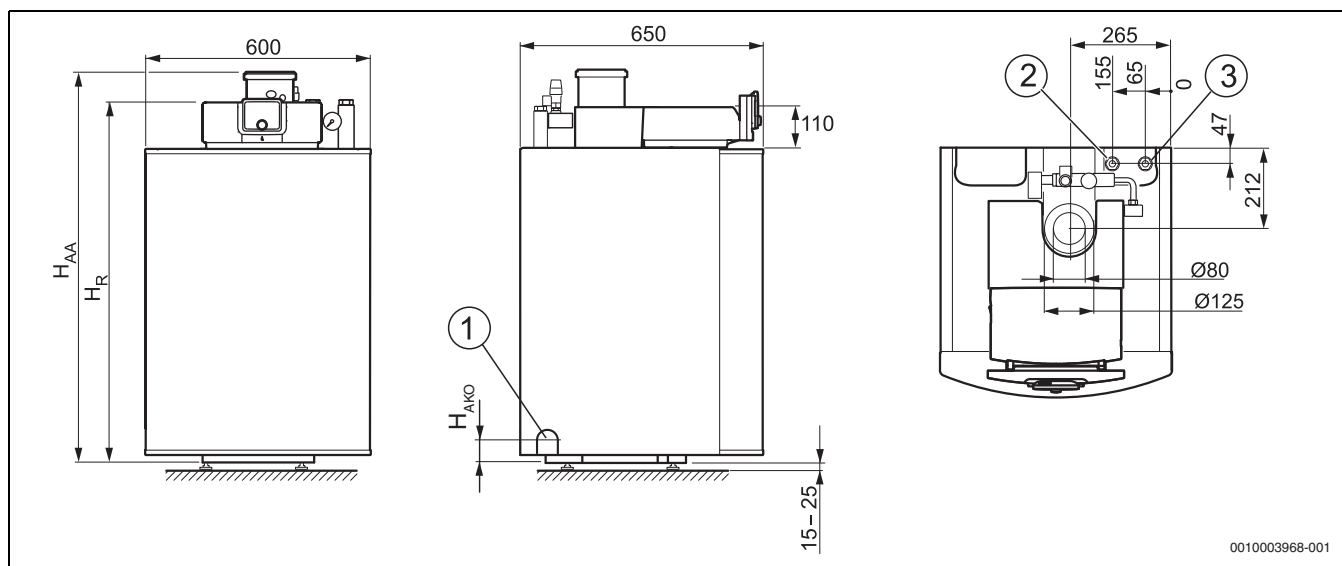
Dimensions et raccordements de la chaudière (en mm)
